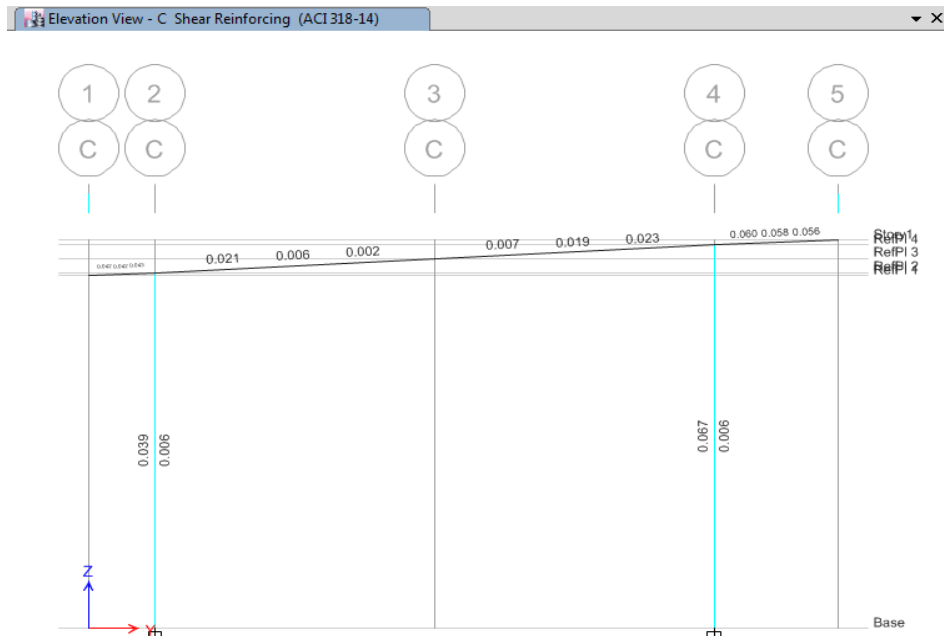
Área de acero por corte de viga (25X60) de Módulo III
